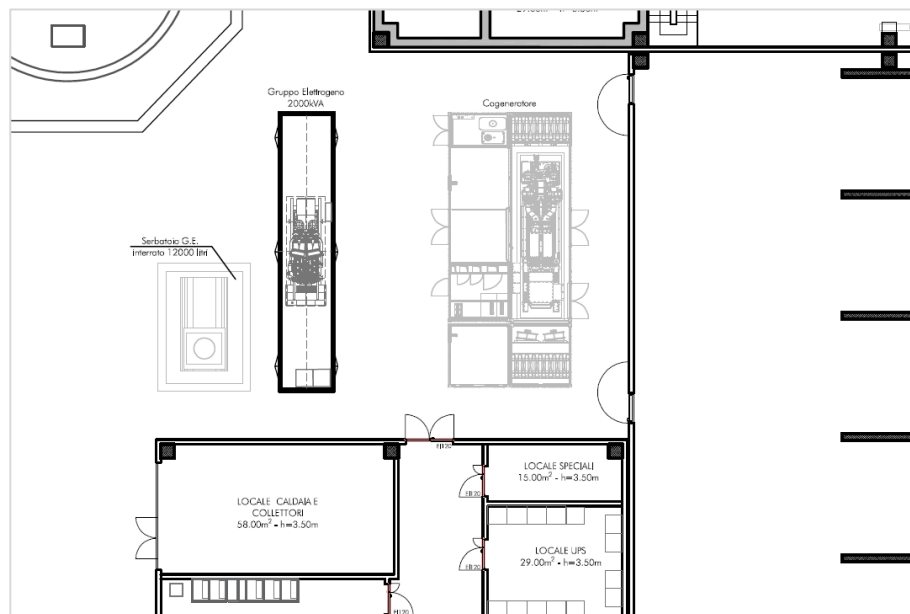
Aree esterne occupate dal cogeneratore_ Stralcio dalla planimetria generale
